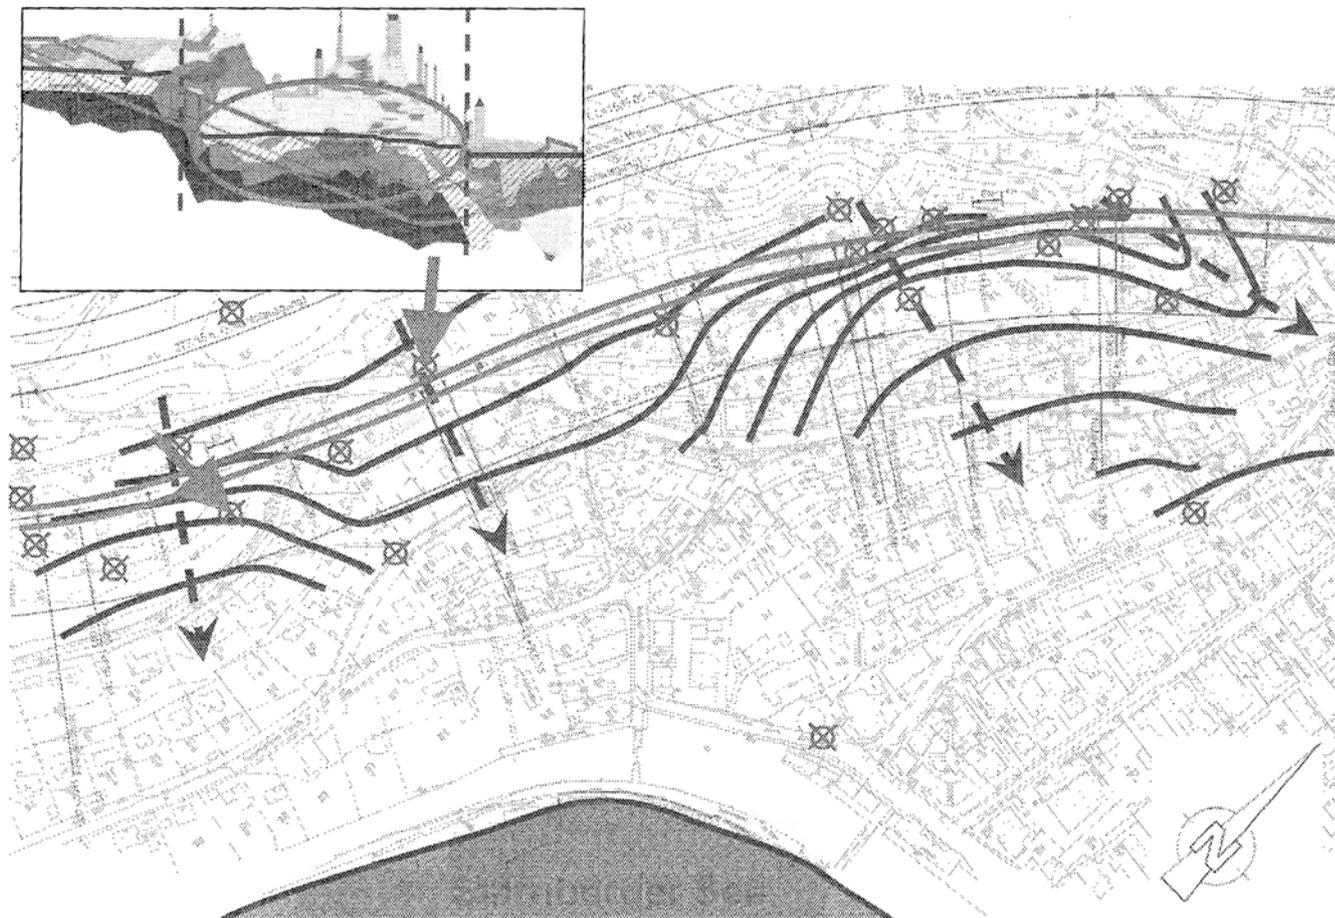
Grundwasserabschnitt 2, mittlerer Tunnelabschnitt
